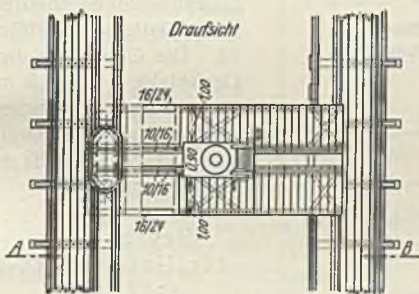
Schütтанlage für das Einbringen des Unterwasserbetons.
